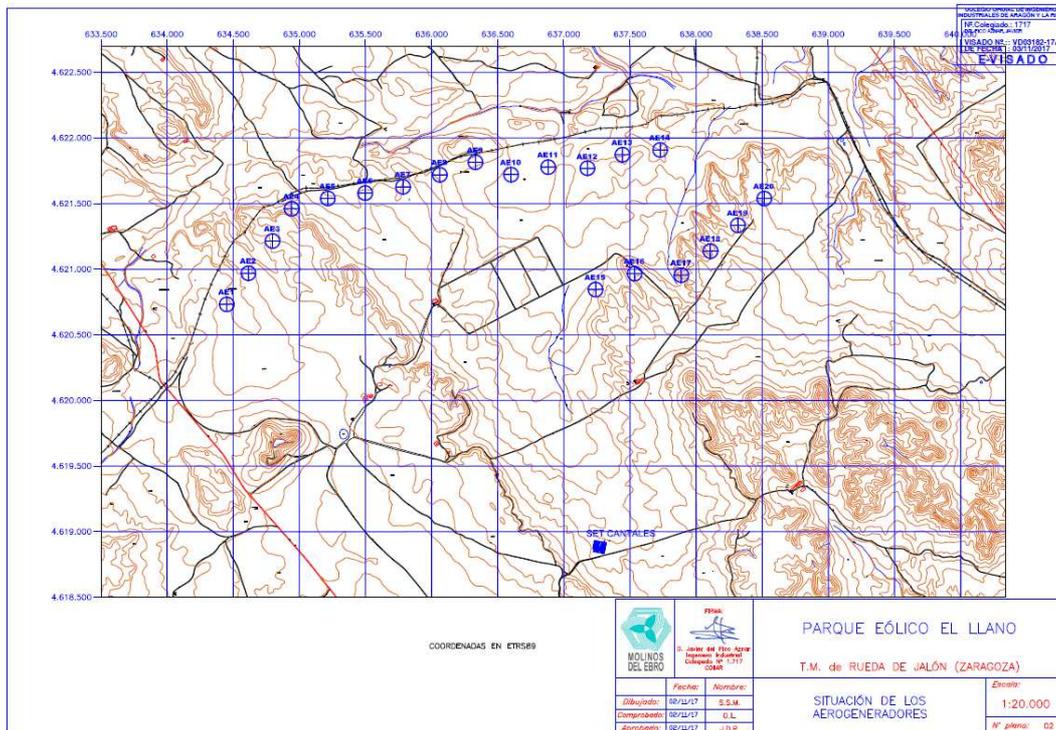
Situación aerogeneradores Parque Eólico El Llano (Fuente: Modificado Proyecto de Ejecución).
